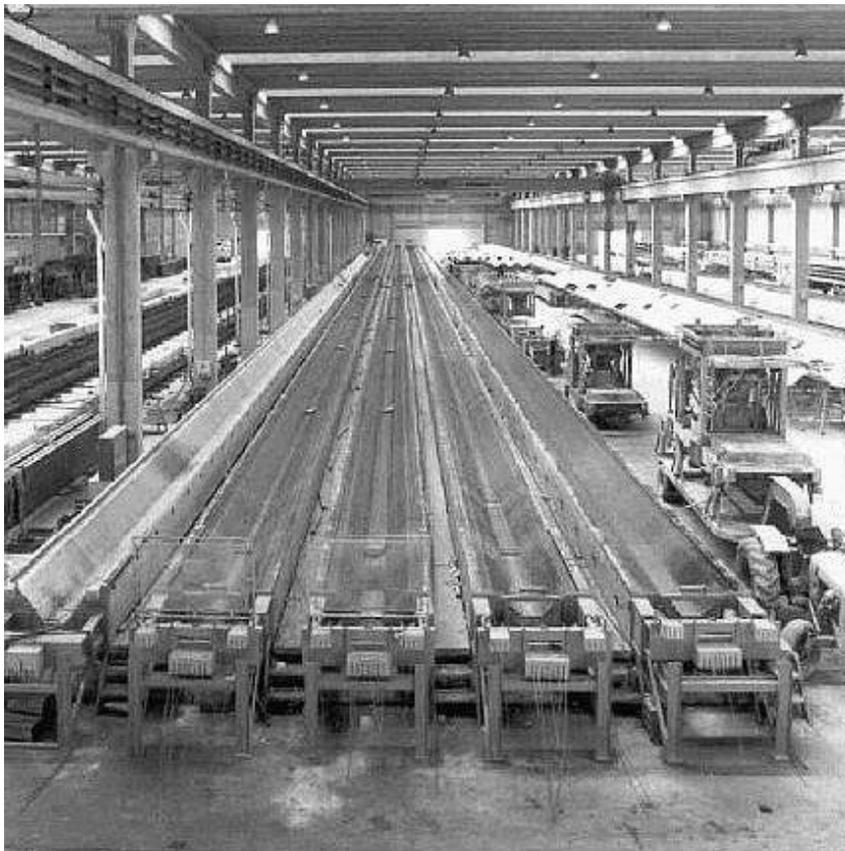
Pista de pré tensão para fabricação de vigas pré moldadas. (Fonte Emerick, 2005)
